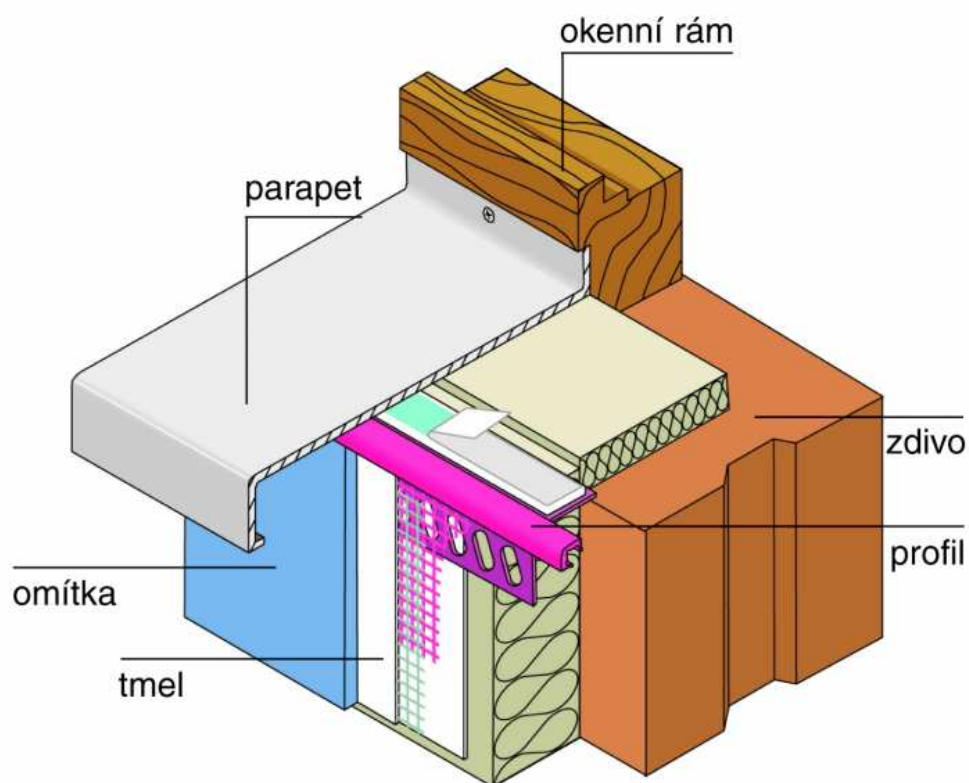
Detail - zakončovací profil s okapnicí a tkaninou
